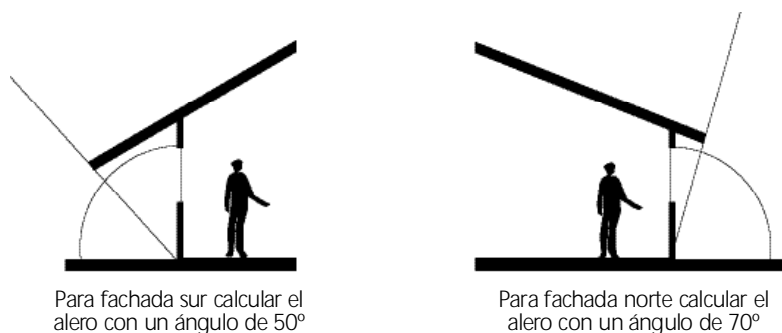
Detalle de aleros y/o protecciones horizontales en fachadas sur y norte
